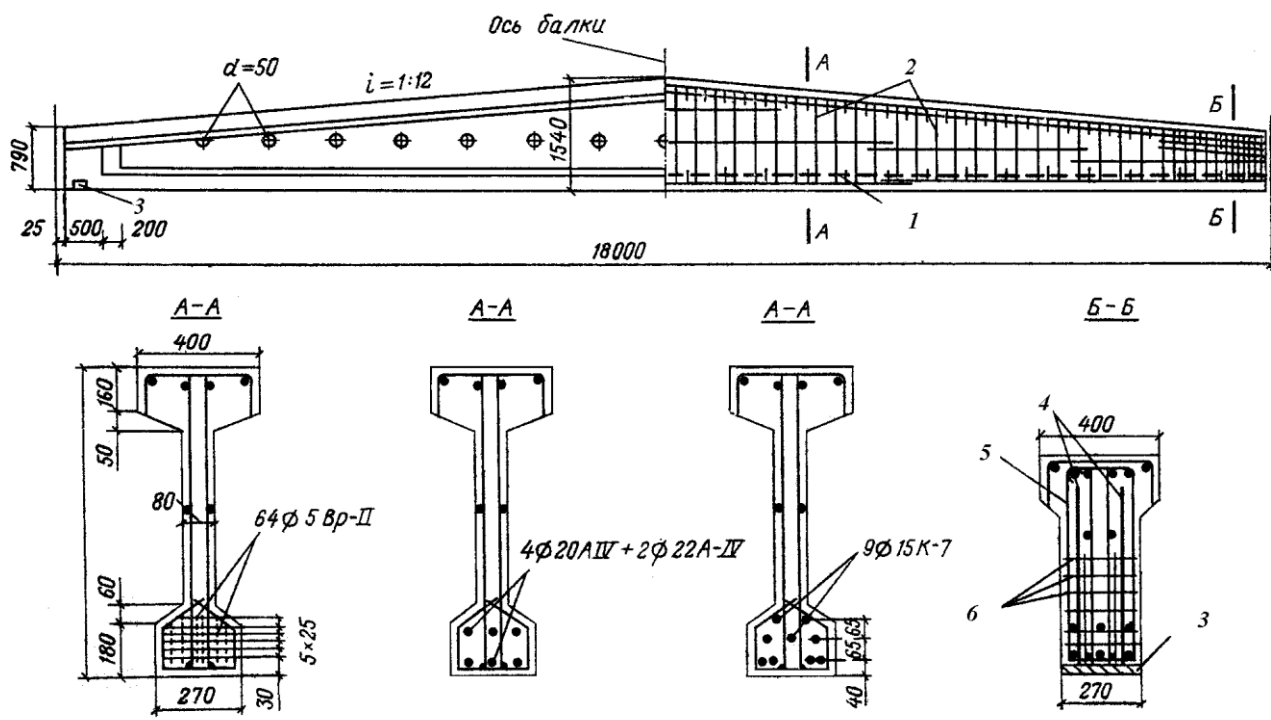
Двухскатная балка покрытия двутаврового сечения пролетом 18 м:
